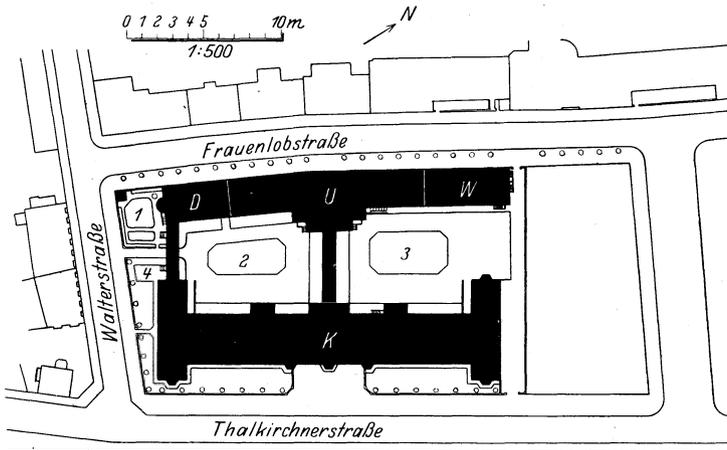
Lageplan der Bauanlage der dritten medizinischen (dermatologischen) Abteilung des städt. Krankenhauses l. d. Isar in München.
